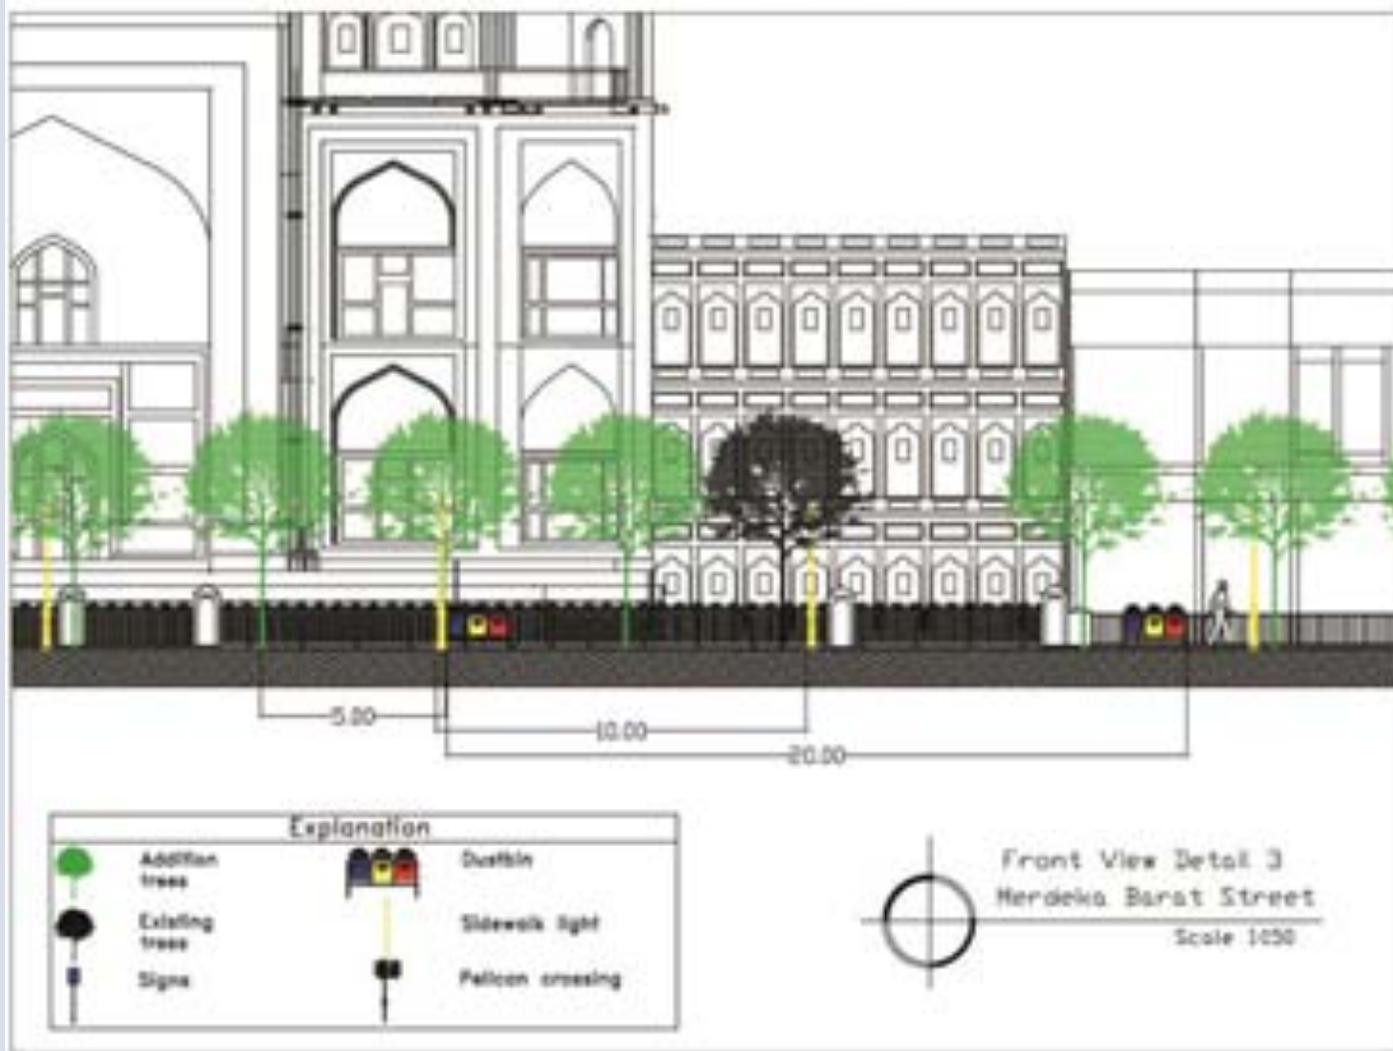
69 Tampak Depan Jalan Merdeka Barat
